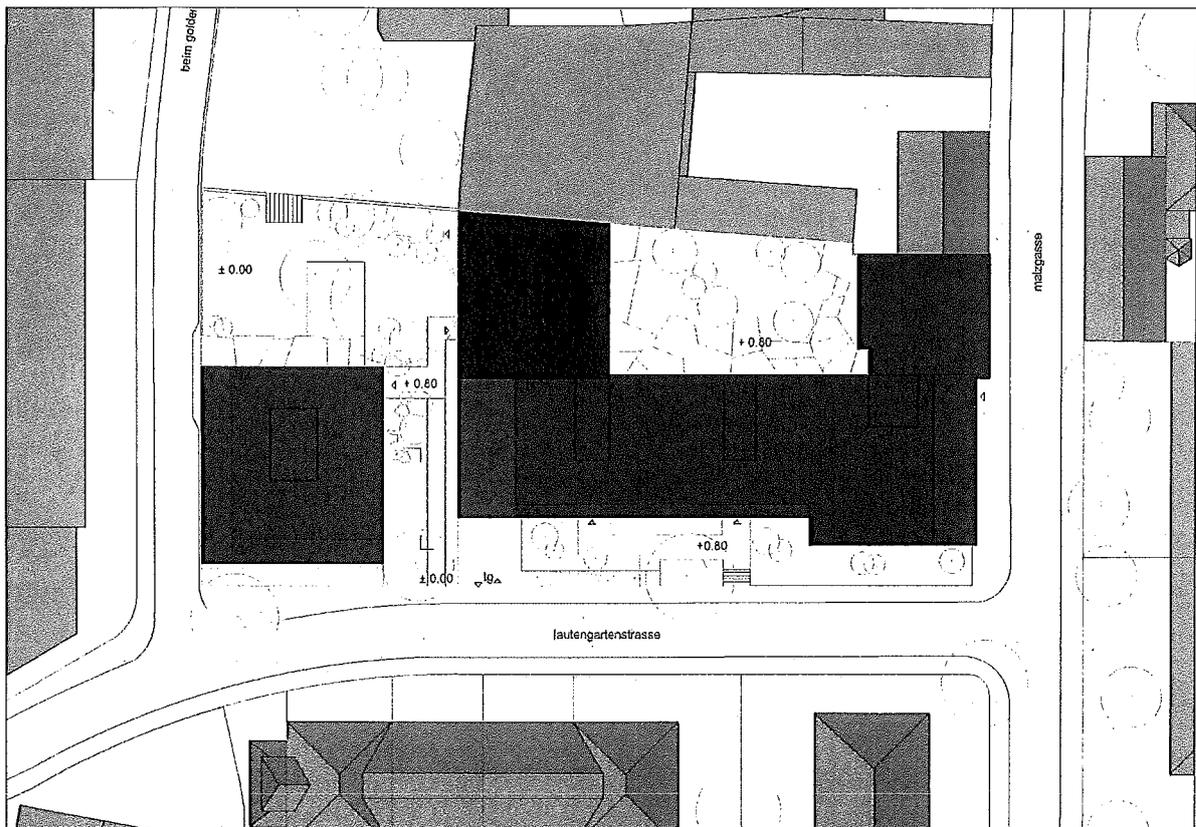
Vorprojekt Lautengarten von Jessen+Vollenweider. (kein Massstab, Plan nicht genordet)
